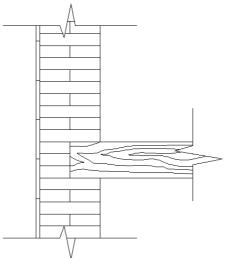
Encuentro viga de madera con muro, enfoscado o alicatado. Fuente: Edición propia
